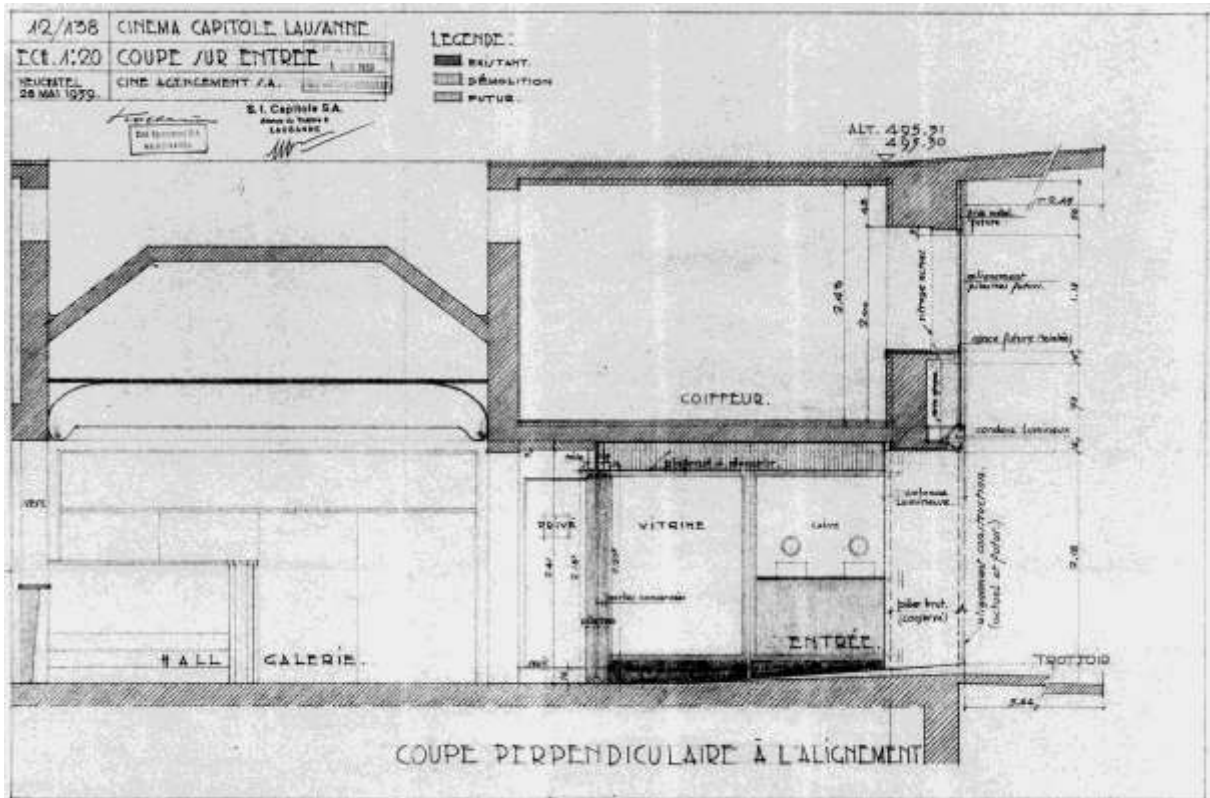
Coupe sur l'entrée, Gérald Pauchard architecte, 28.5.1959 (AVL).
